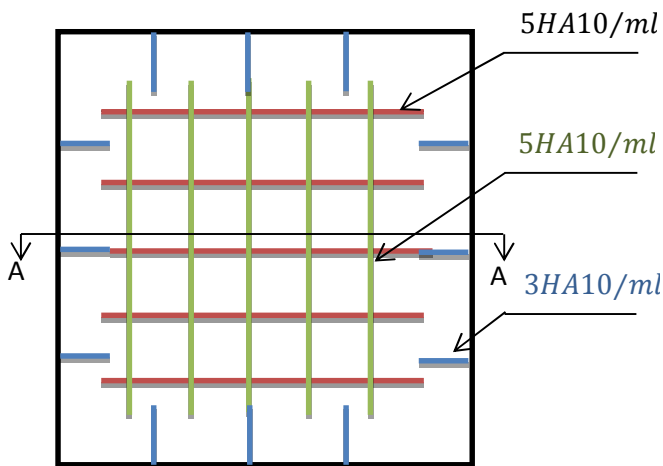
Schéma de ferrailage de la dalle au-dessus de l'ascenseur.
